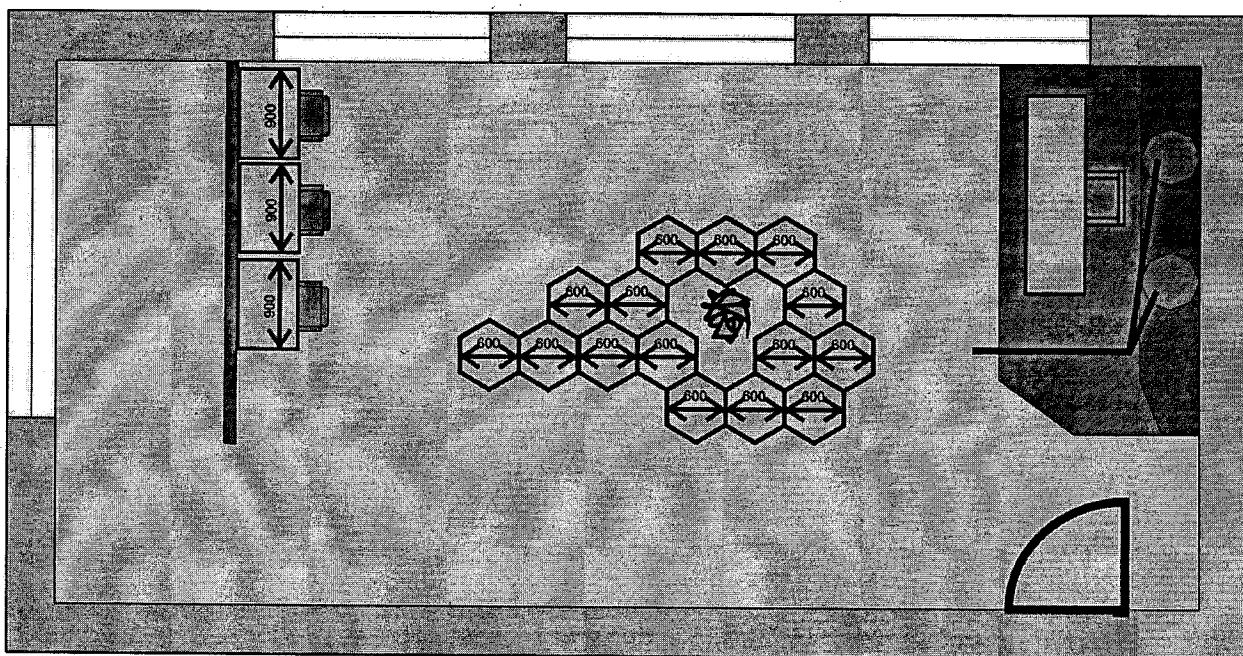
План размещения оборудования в помещении «Космоквантум»
